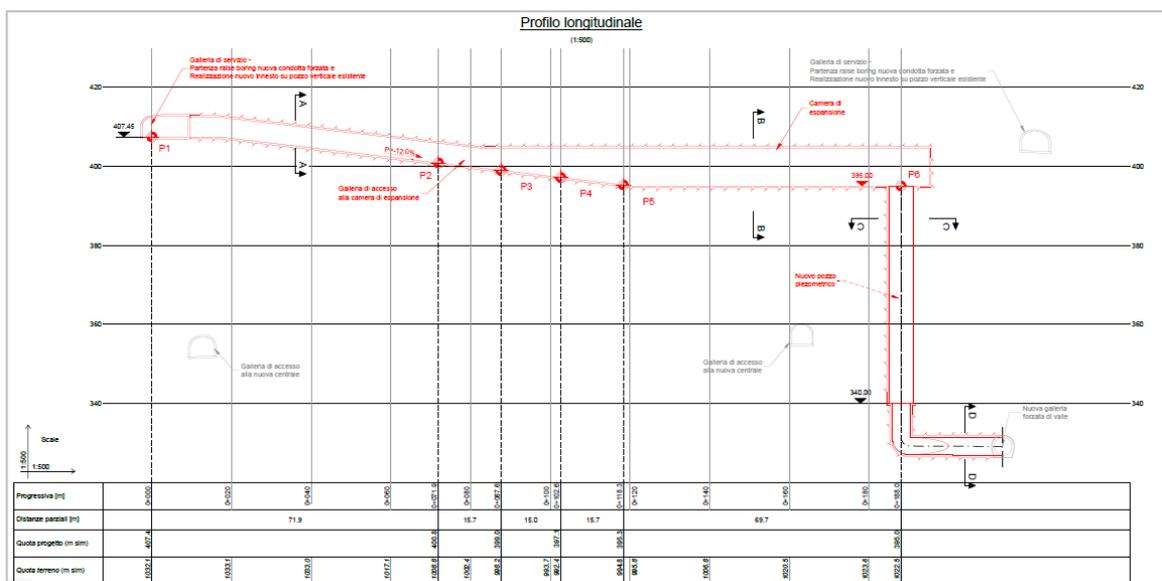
Nuovo pozzo piezometrico sulla derivazione Piaganini – profilo
